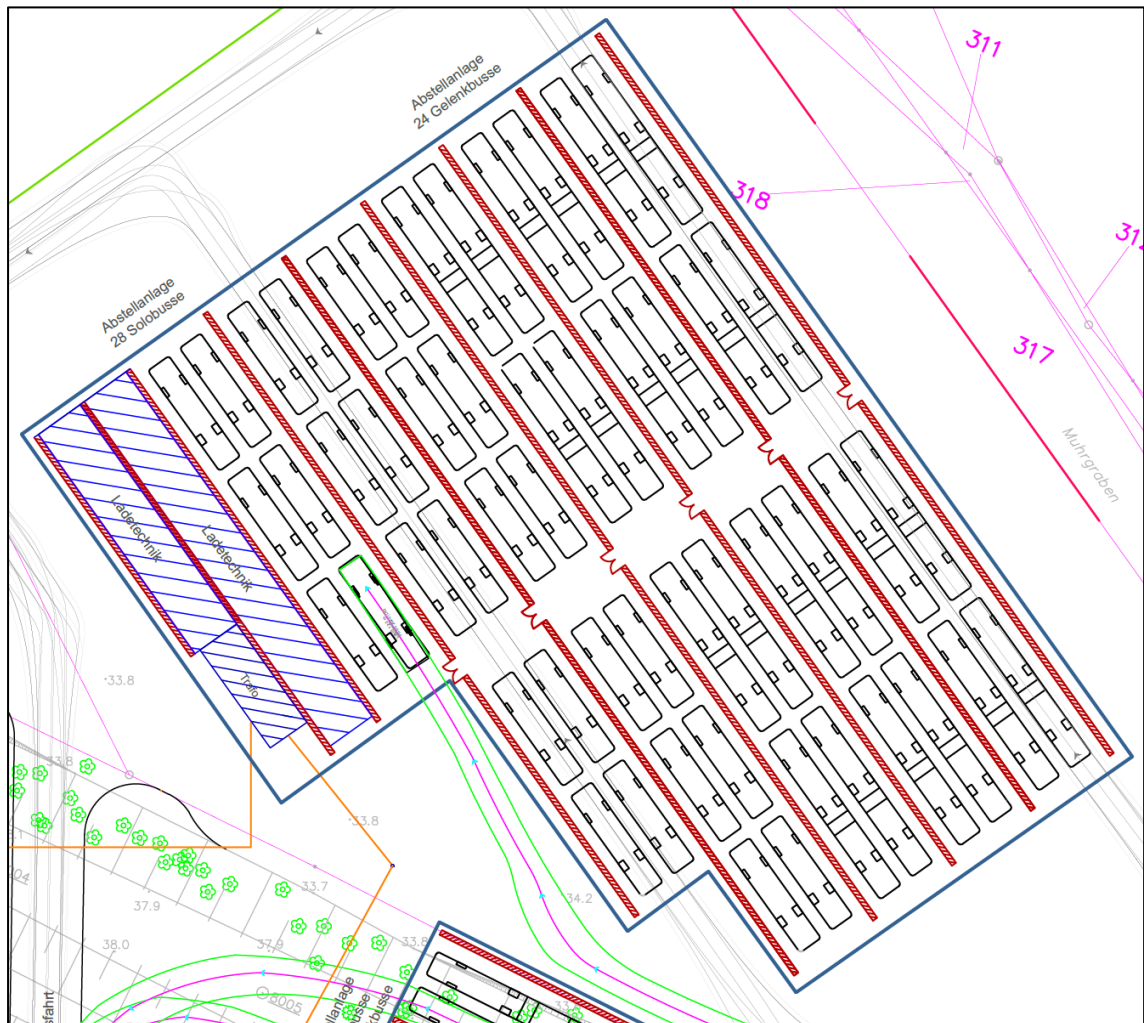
Germendorf Detailansicht Bauabschnitt 3
